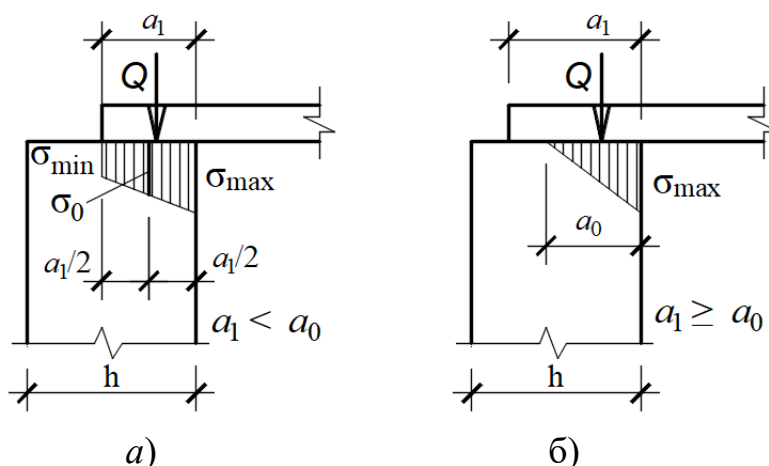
Розрахункові схеми обпирання балок і плит на кам'яні конструкції:
